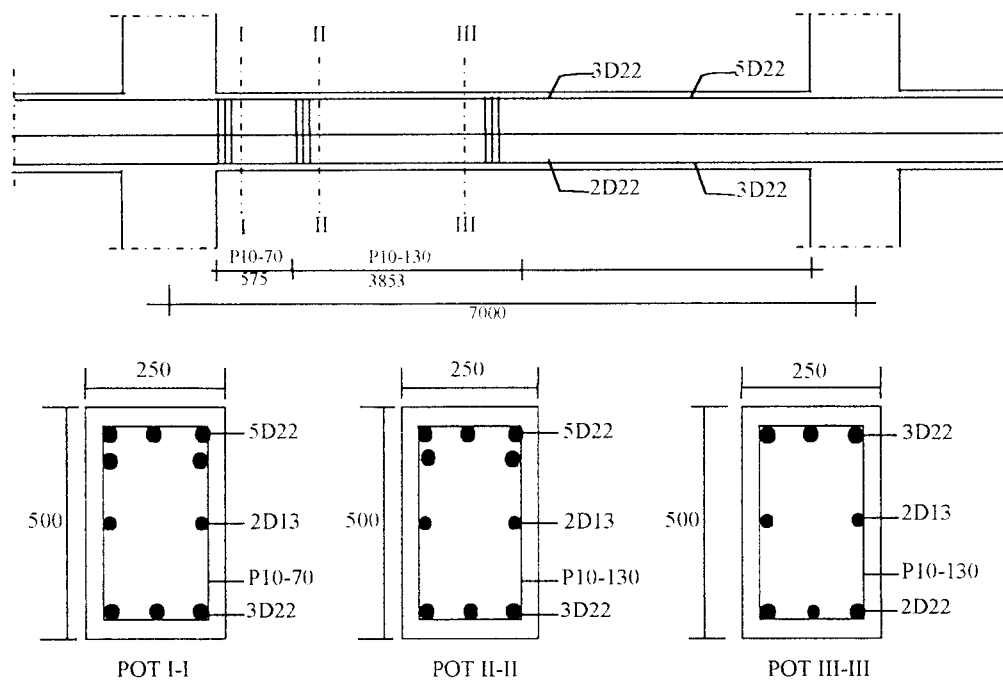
Balok Portal E Bentang 7 m Lantai 4
